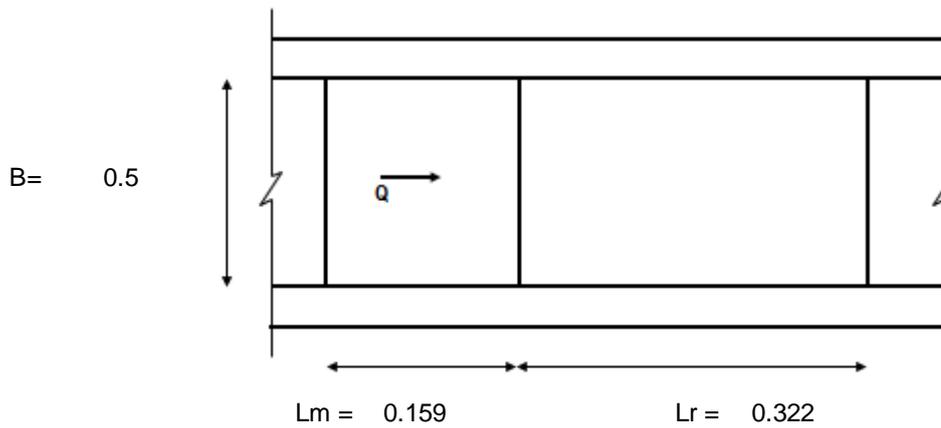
Diseño en planta Mezcla Rápida Tipo Vertedero rectangular (elaboración: Propia)
